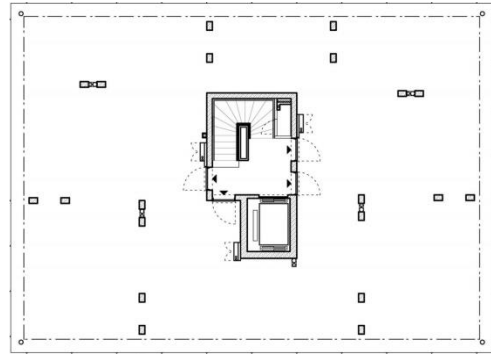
Primera fase de la Grundbau und Siedler. Esqueleto estructural y plantas libres realizado por Bel arquitectos, 2012
